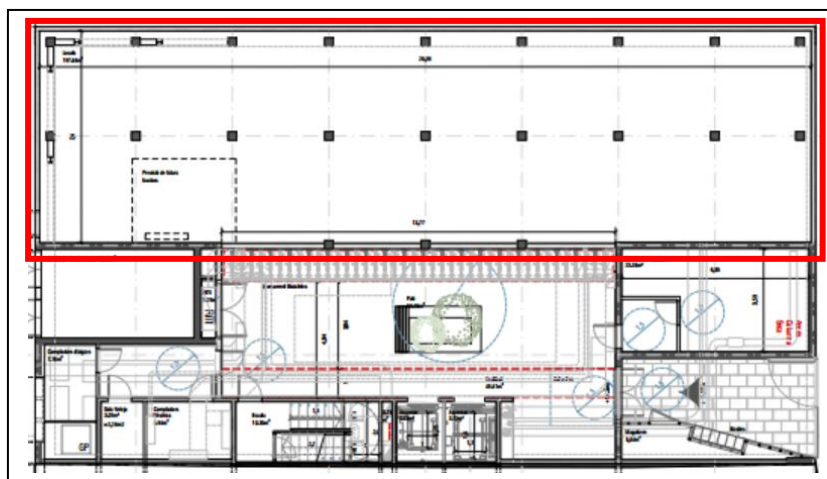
Ubicación en planta baja del recinto emisor del ensayo ACU-24-119841 (25).
